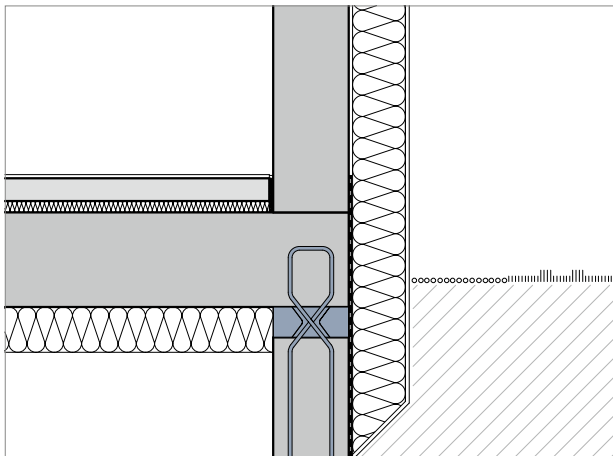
Schöck Sconnex® Typ W bei Außenwand und Unterdeckendämmung
